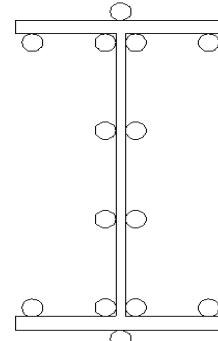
Propuesta para la distribución de Varillas en el perfil W (Planos Constructivos)
